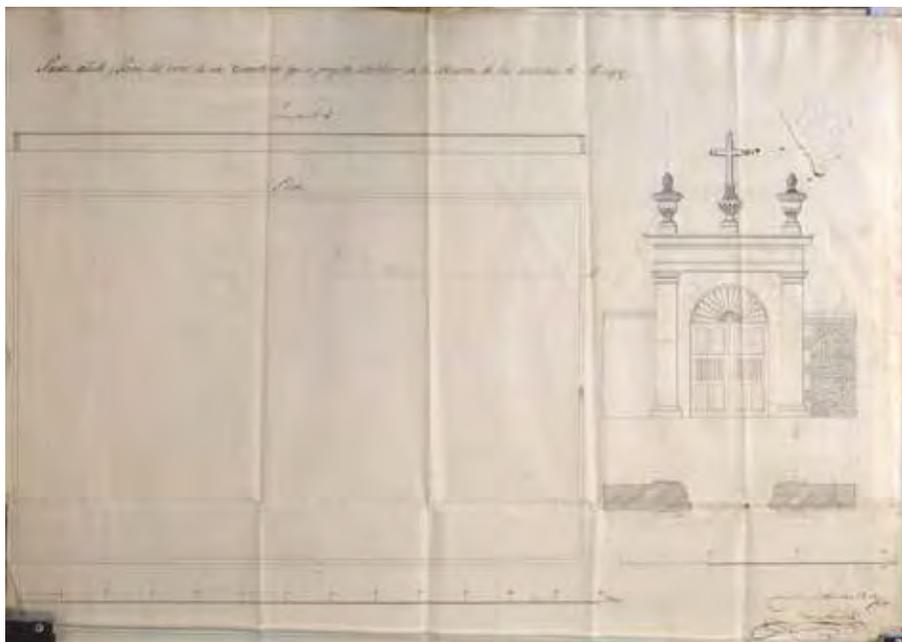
Plano y portada del Cementerio General de Lugo. 1858. Juan Armesto.
